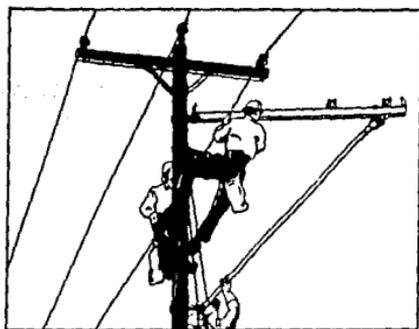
b) Por medio del bastón elevador se levanta hasta que se obtiene una posición horizontal.
